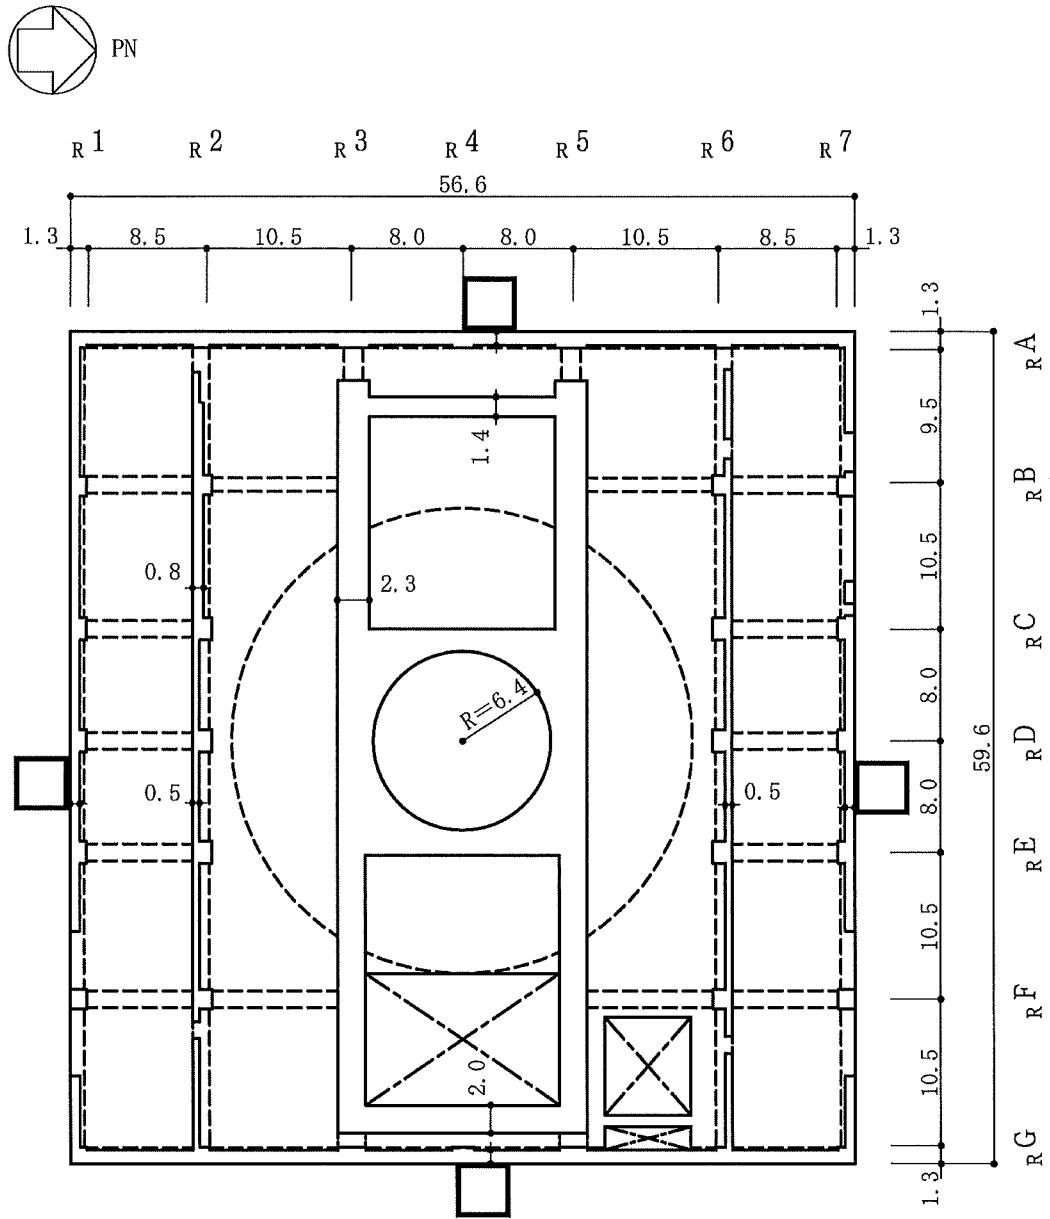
原子炉建屋の概略平面図 (3F, T.M.S.L. 23.5m) (6/9) (単位 : m)
